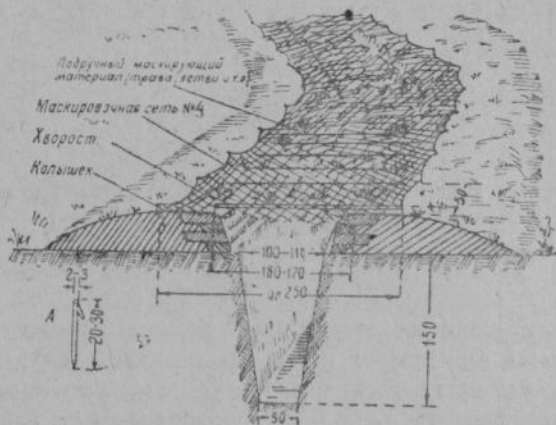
Перекрытие хода сообщения маскировочной сетью.
